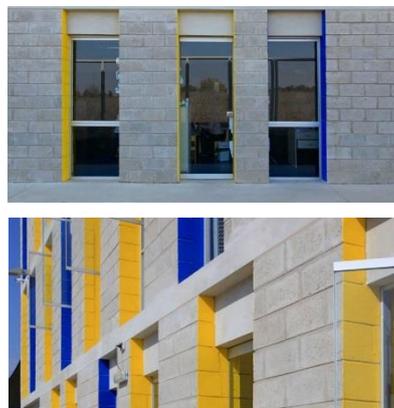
Vista de Fachada de Futura Schools – Ica
